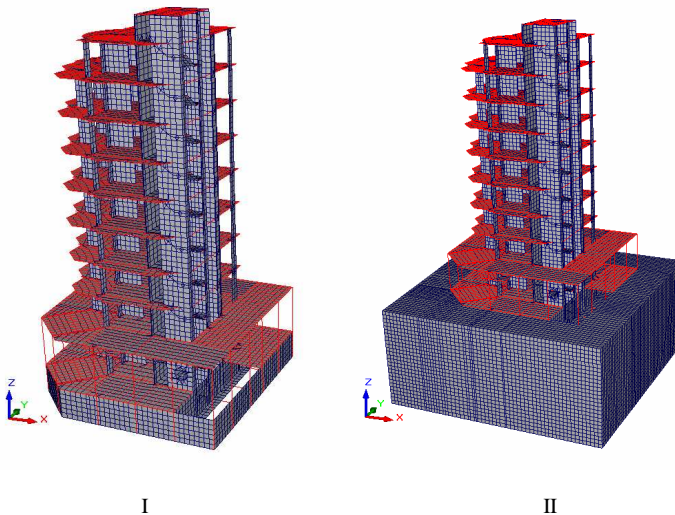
Вариант (А) – конечно-элементные модели расчетных схем 10-этажных каркасно-стеновых монолитных железобетонных зданий с подвалом: I – здание с основанием (А₁, А₂, А₃, А₄, А₅); II – здание без основания (А₆).
